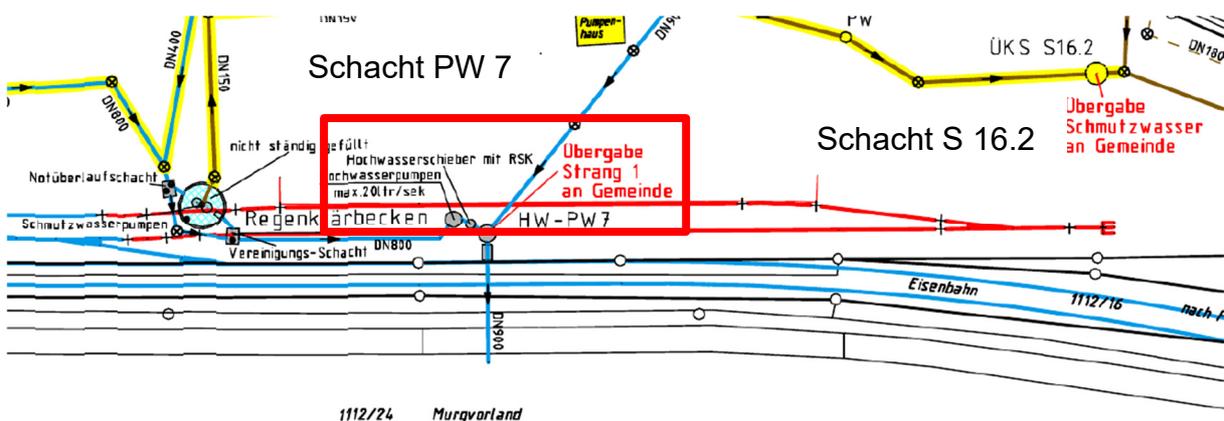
Anschlusspunkte Sägewerk [Auszug Lageplan Vermessungsbüro Klein, 01.12.2005]
